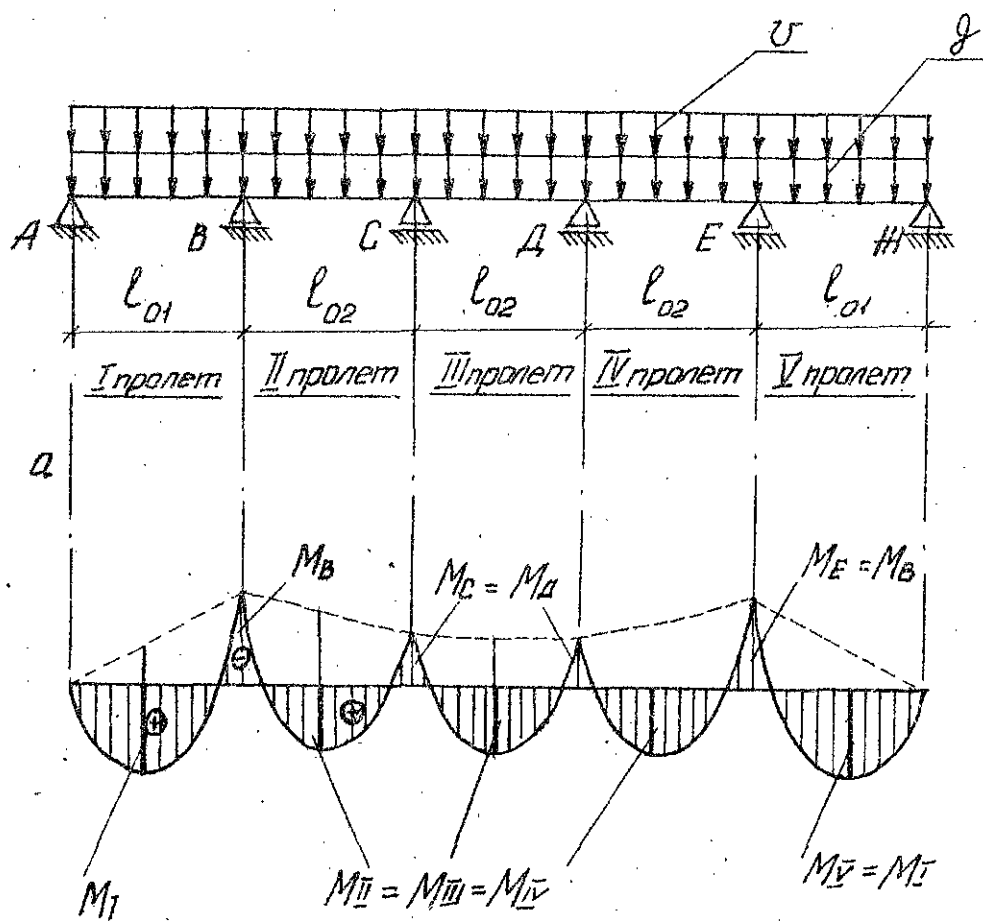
К расчету плиты: а - расчетная схема; б - эпюра изгибающих моментов
